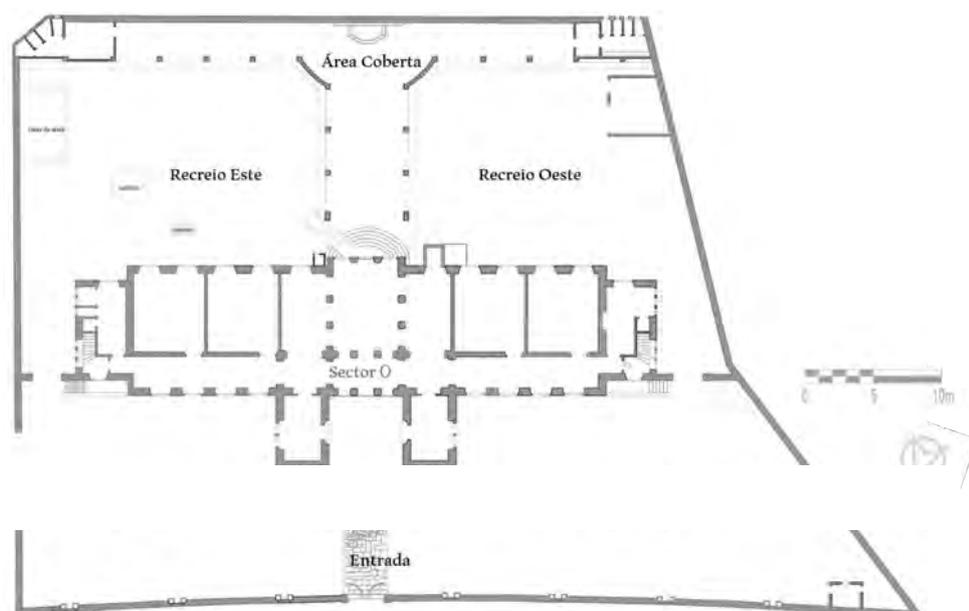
Planta de Implantação do espaço Fonte: (n.d.) Câmara Municipal do Entroncamento
